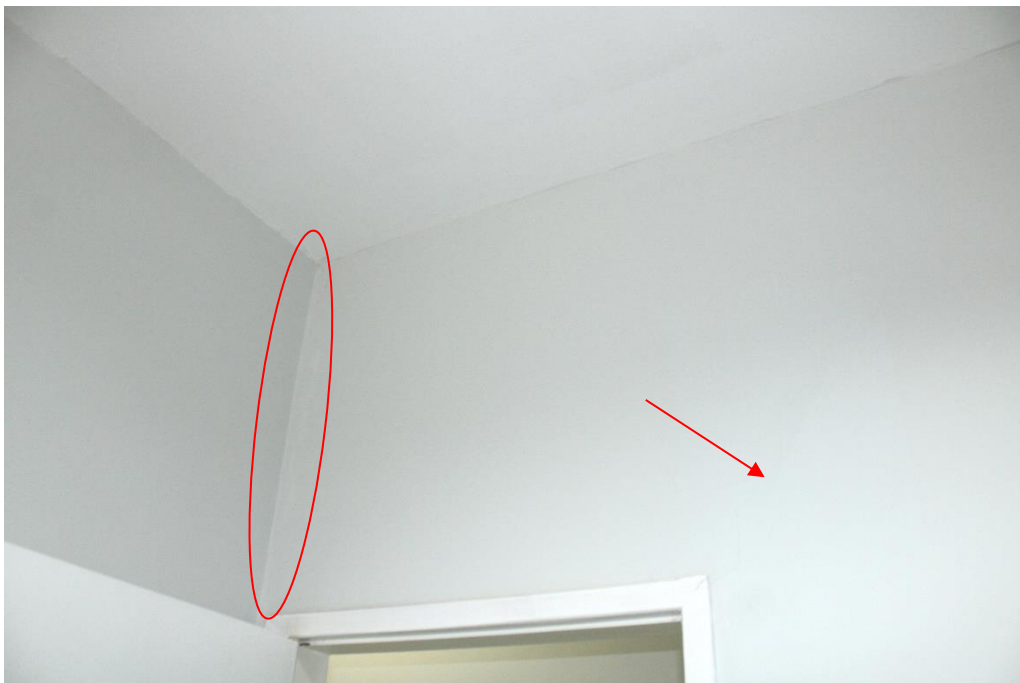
Vista parcial da sala 48, destacando fissura vertical na interface entre paredes e fissura diagonal em vértice superior da porta, ambas com sinais de reparos pretéritos.
